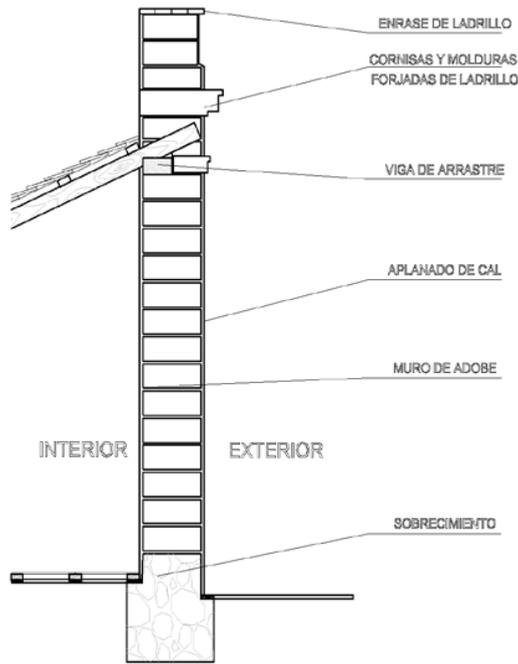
Corte por fachada de vivienda de un nivel en Tenango del Valle.
